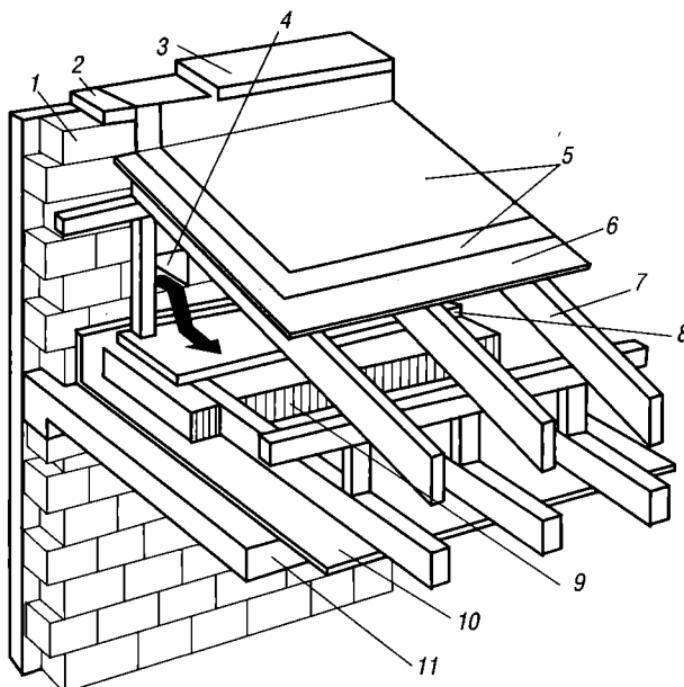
Конструкция вентилируемой бесчердачной крыши:
